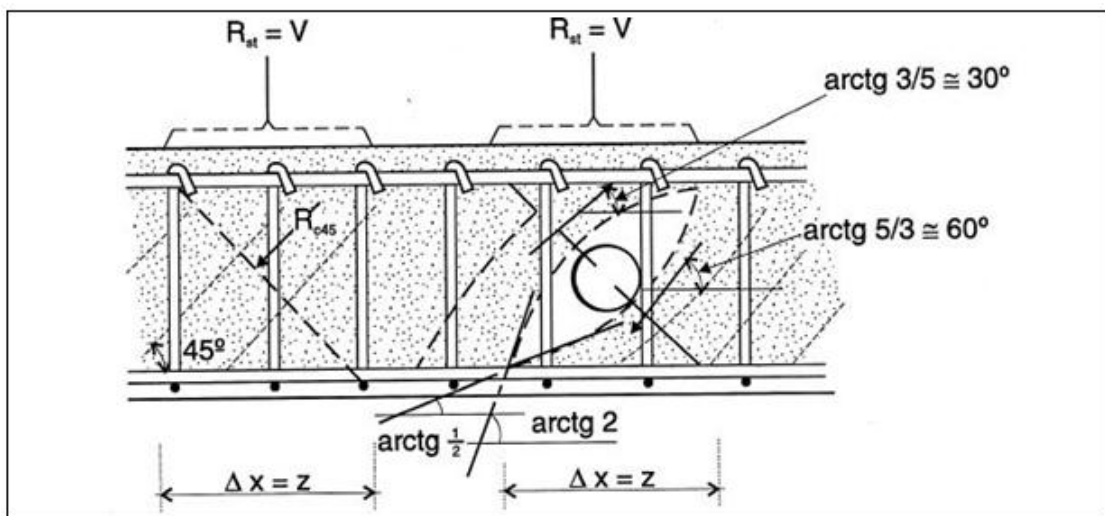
Detalhamento das armaduras das vigas com aberturas
